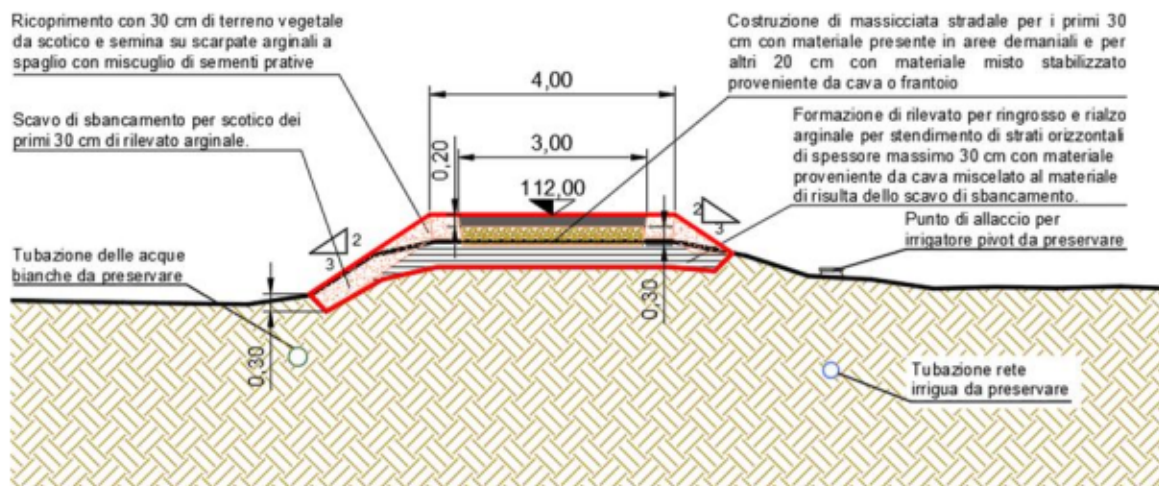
SEZIONE TIPOLOGICA DEL RINGROSSO DELLO STRADELLO TRA LA SEZIONE M01A E LA SEZIONE M04
